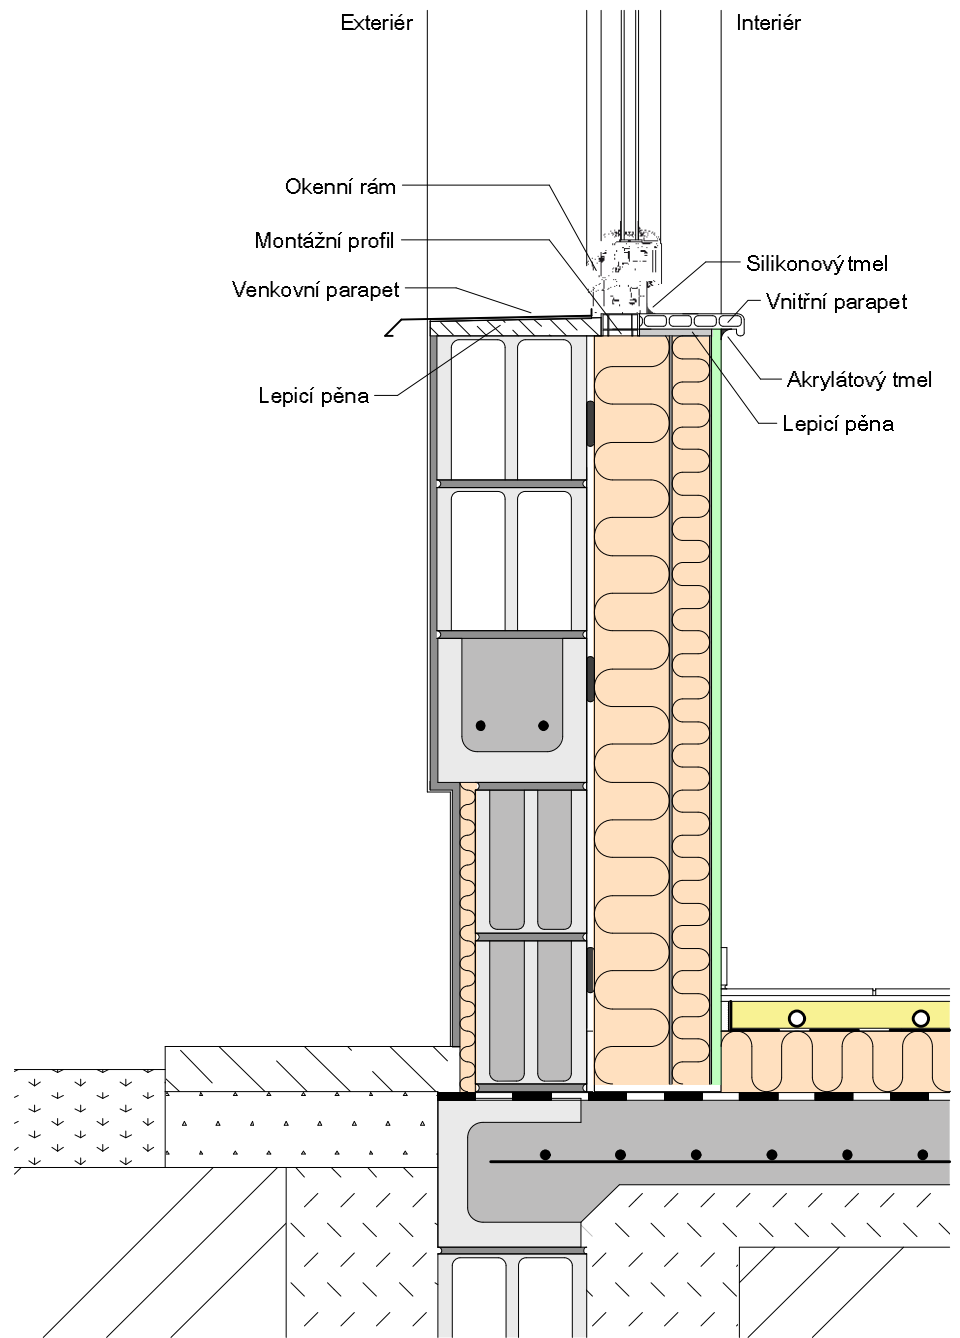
OBVODOVÁ STĚNA - OKNO PŮDORYSNÝ ŘEZ
